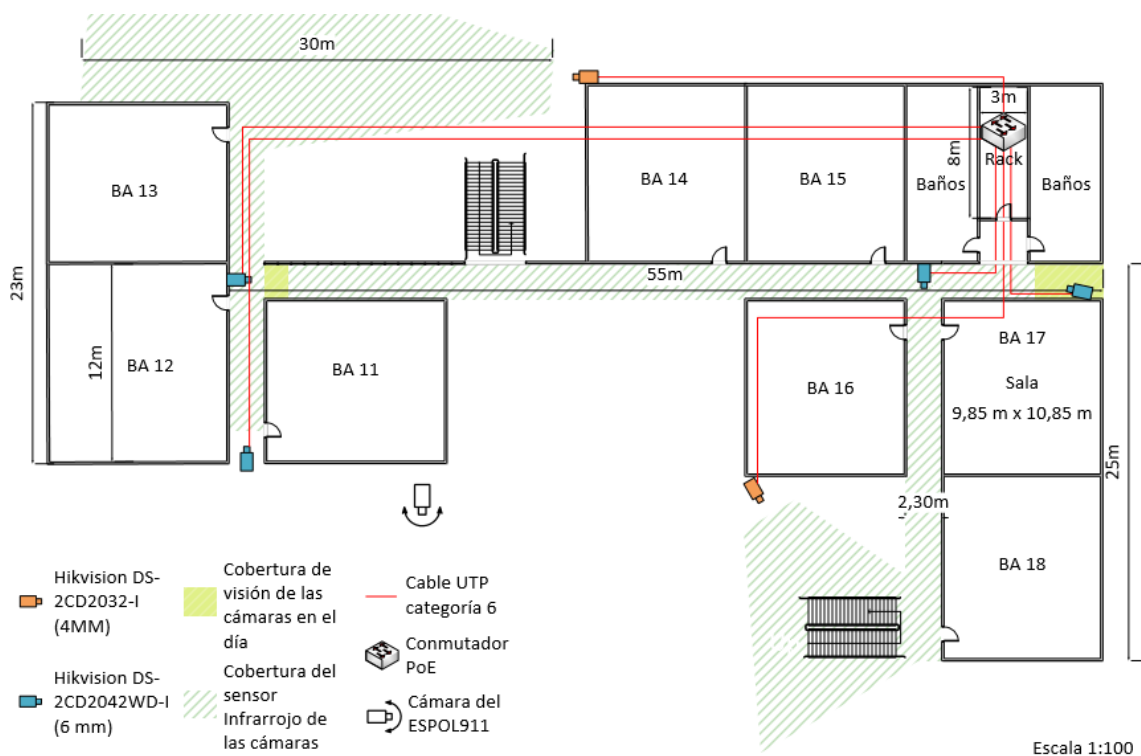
Ubicación de las cámaras el edificio 32 A, planta baja.
